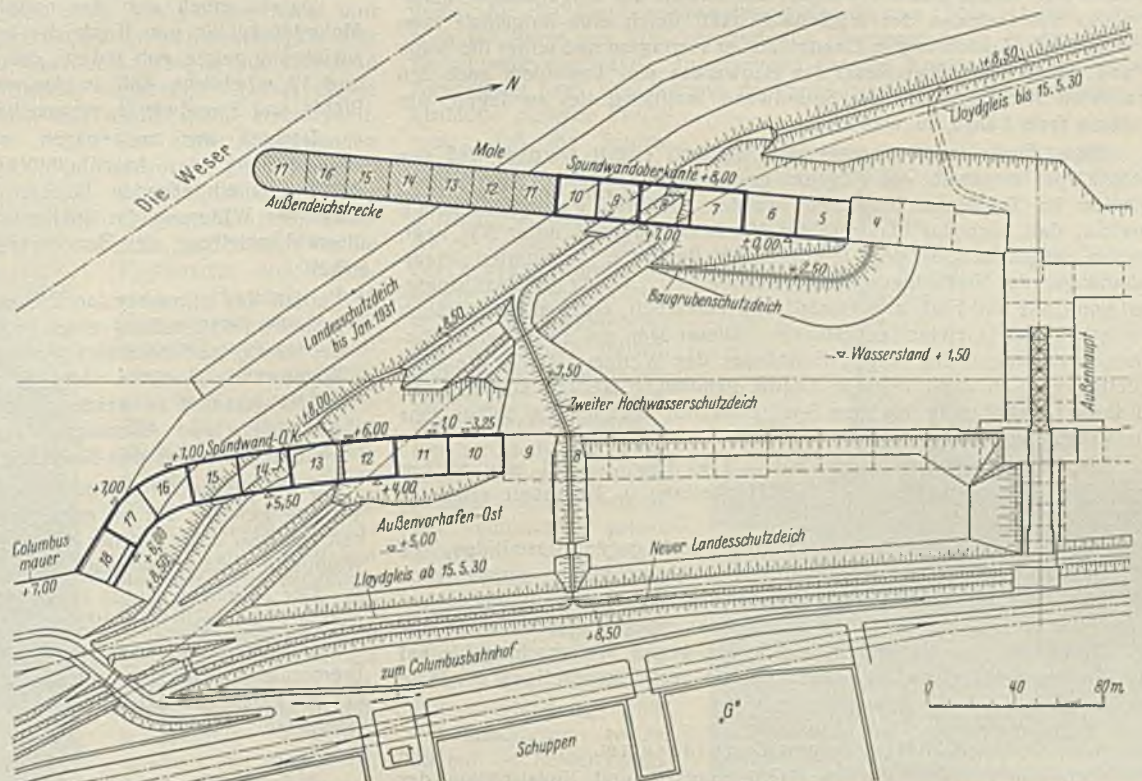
Lageplan für die Durchbaggerung des Weserdeiches.
